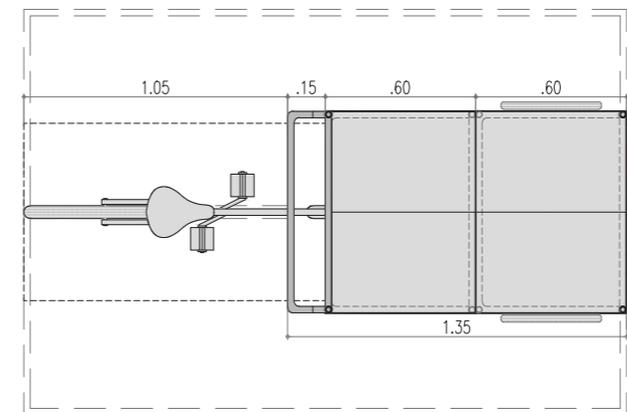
Planta puesto de venta semi-estacionario tipo 4. Esc 1:30
